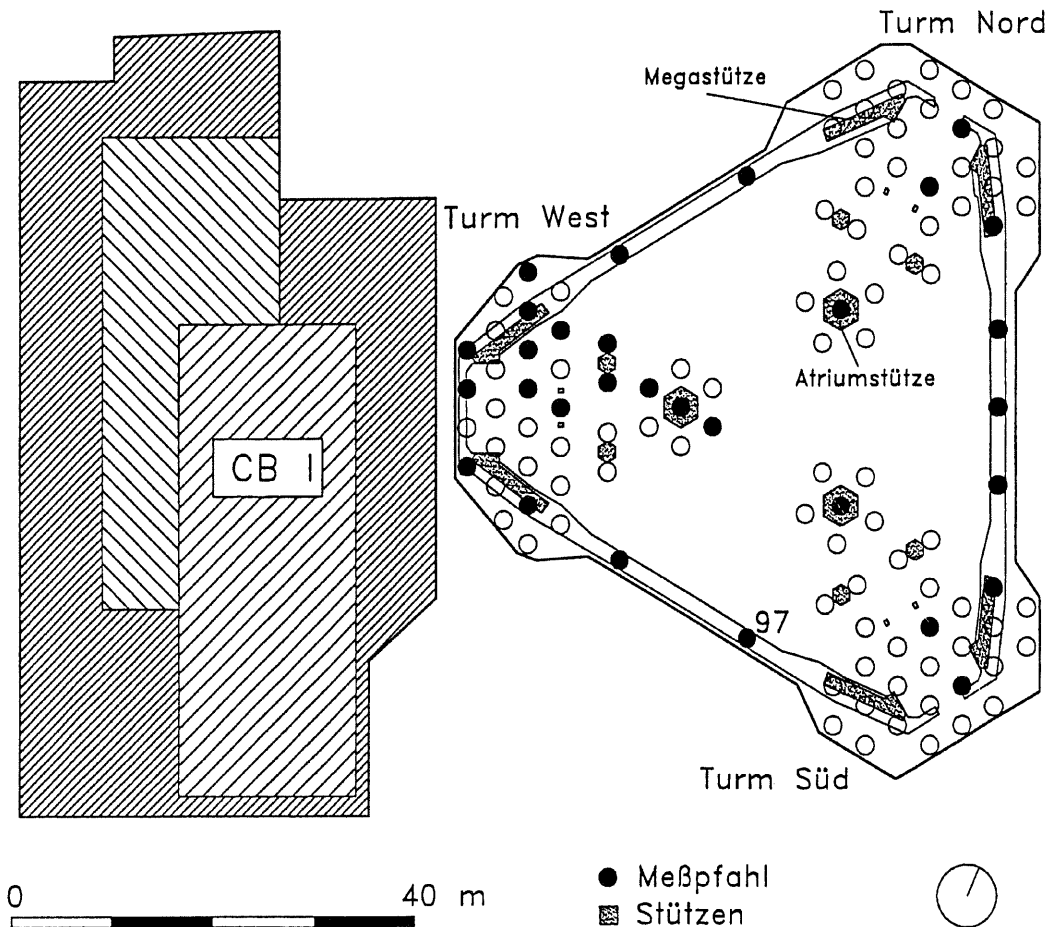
Commerzbank-Hochhaus - Grundriß (Holzhäuser, 1996)
